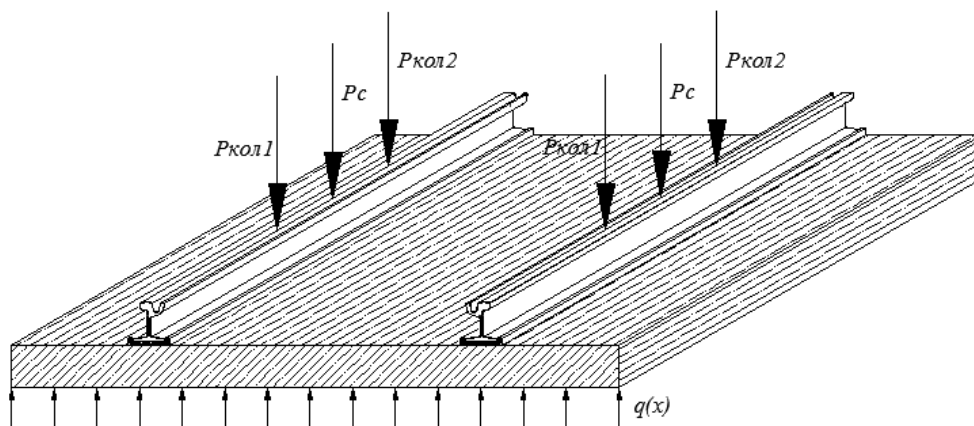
Схема передачи нагрузки на несущее бетонное основание при коэффициенте постели подошвенного вкладыша 10 МПа/м до 130 МПа/м
